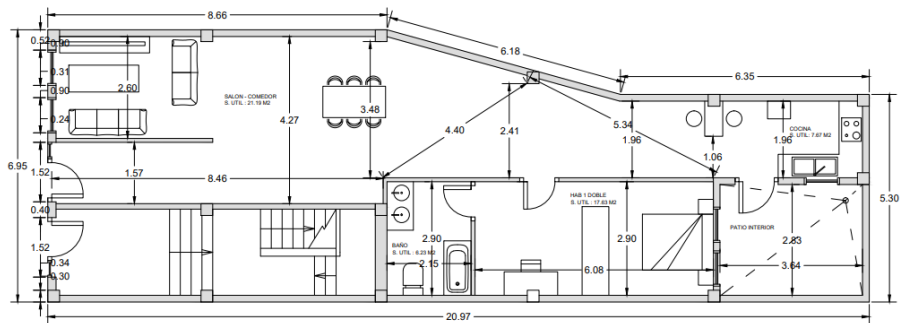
Plano acotado estado reformado. Fuente: Propia.
